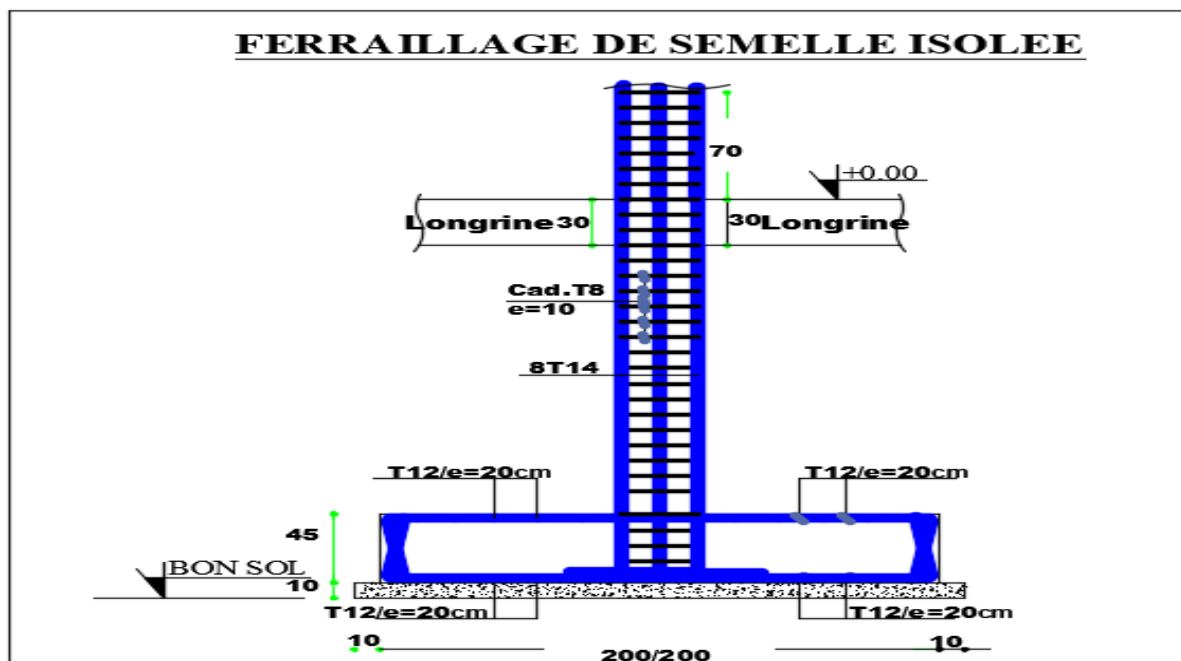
Schéma des Ferrailage de la semelle isolée.
